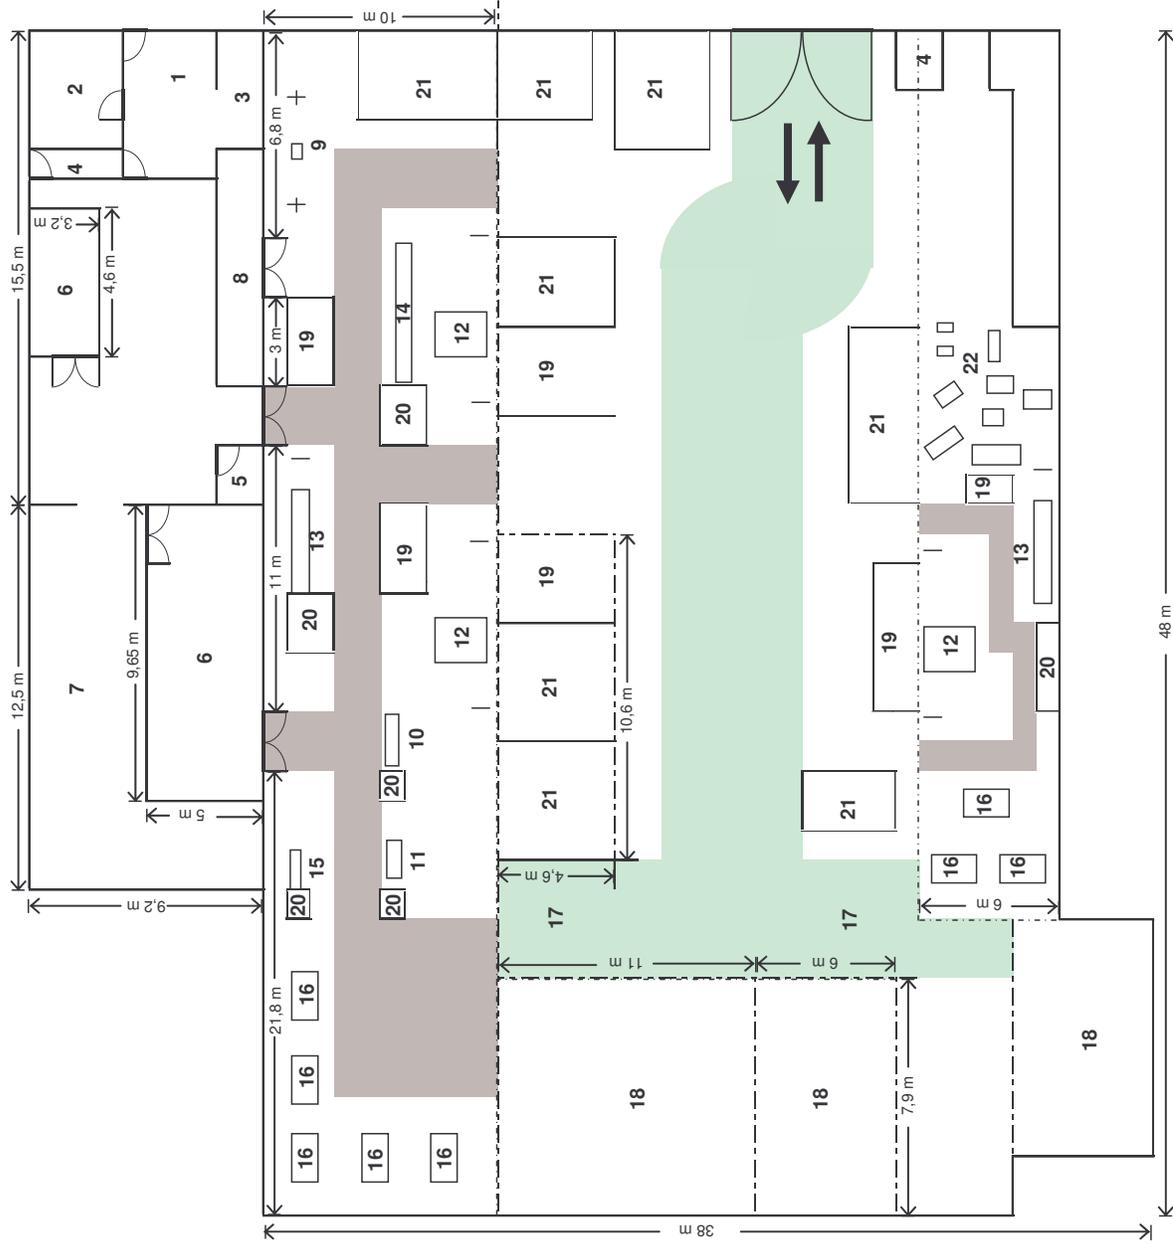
Propuesta de distribución en planta en Maderas El Ceibal Ltda. Fuente: Los autores del proyecto.
